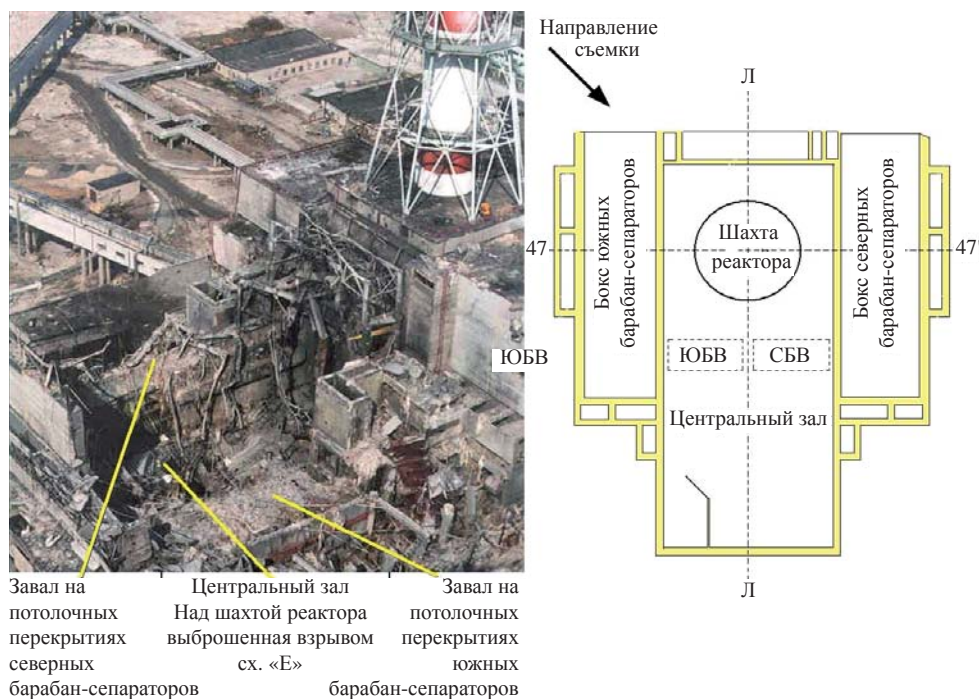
Вид на развал реактора с юго-запада (с вертолета) и схема верхних помещений
